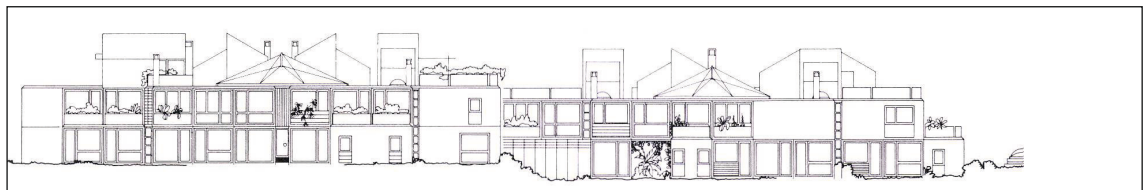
Fassadenansicht von zwei Atriumhäusern der Anlage Les Palétuviers III
